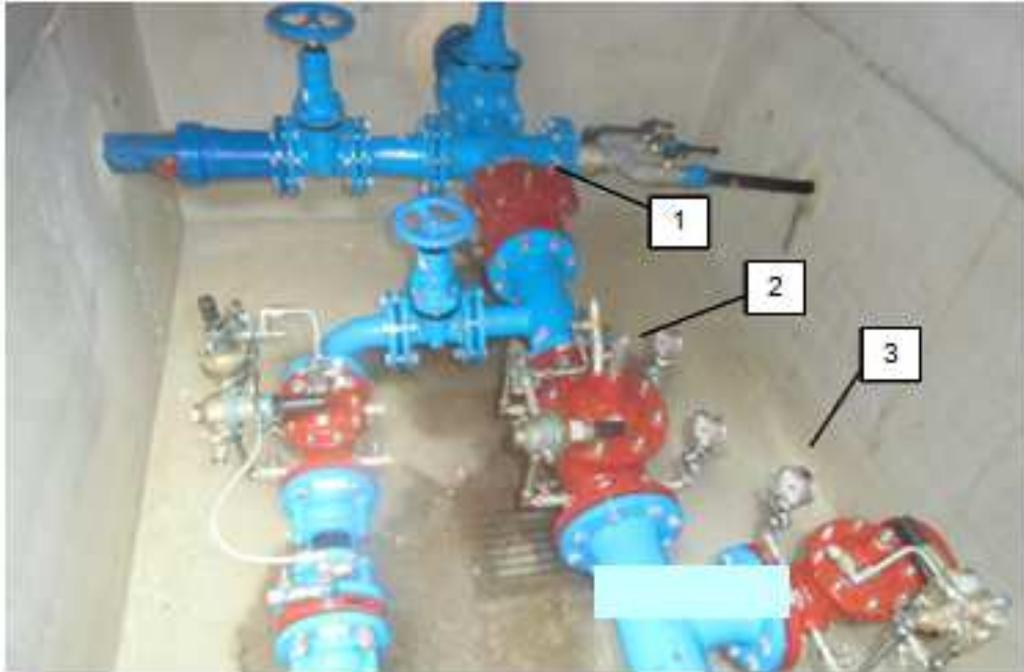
Einbauschema eines Druckreduzierventils mit Bypass
